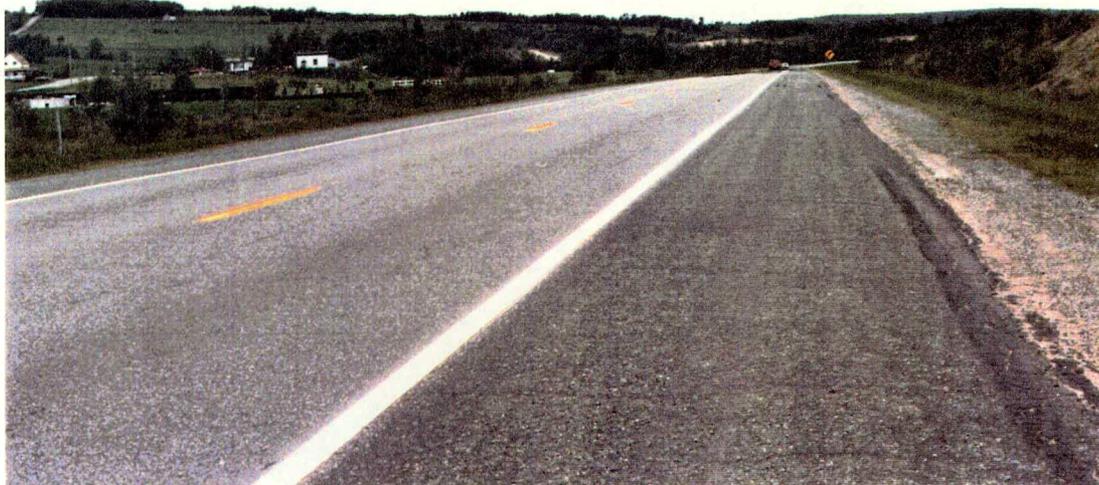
DIRECTION DRUMMONDVILLE; VUE OUVERTE SUR LA ZONE AGRICOLE.
